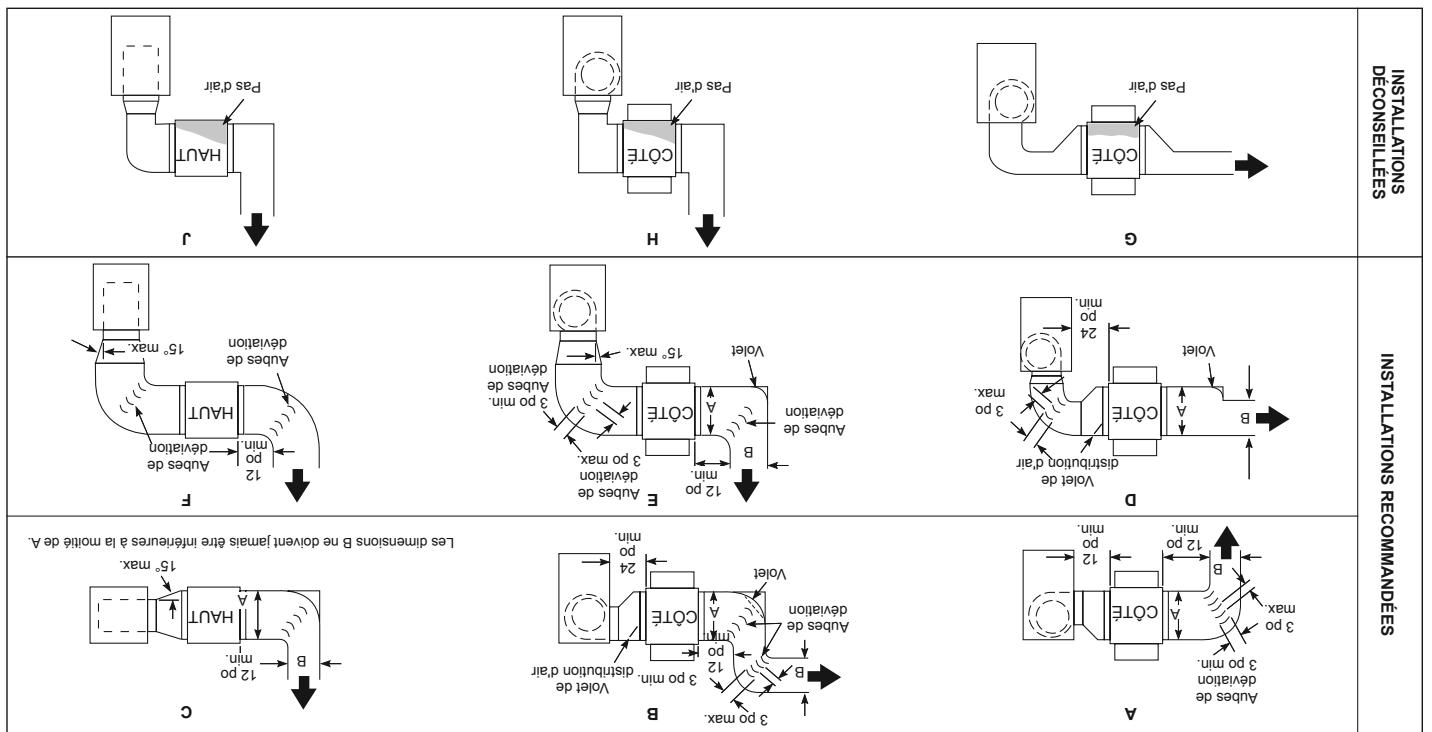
Installation typique – canalisations et circulation de l'air
